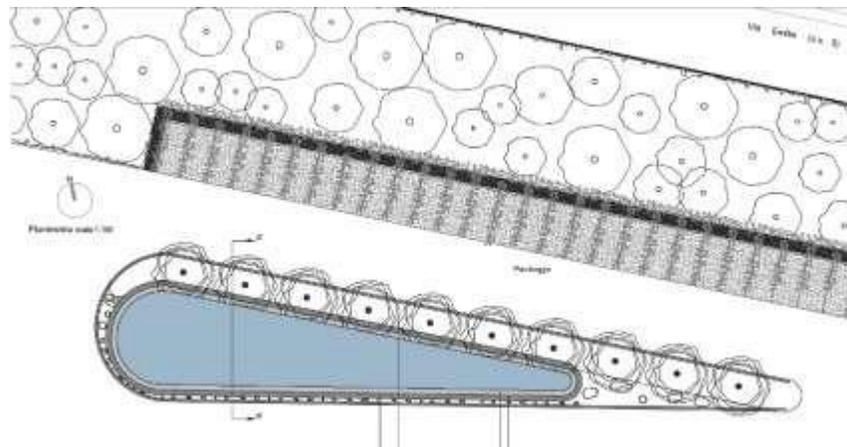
Bacino di infiltrazione OVEST - Pianta
